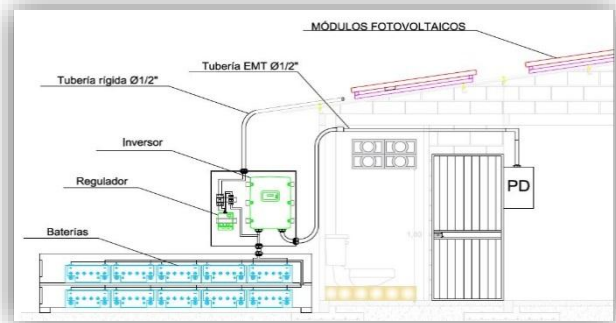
Implantación del s.f.v. aislado en AutoCAD.
